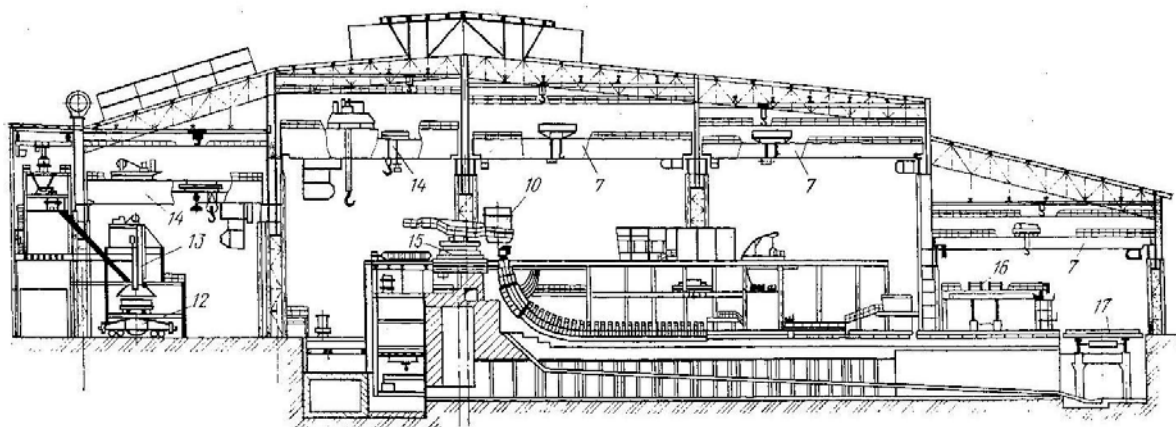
Поперечный разрез отделения непрерывной разливки стали конвертерного цеха ОАО «Северсталь»: 7 — мостовой кран; 10 — сталеразливочный ковш; 12 — самоходный стелевоз; 13 — установка стабилизации и доводки металла; 14 — мостовой разливочный кран; 15 — МНЛЗ; 16 — кран-оператор; 17 — рольганг-тележка
